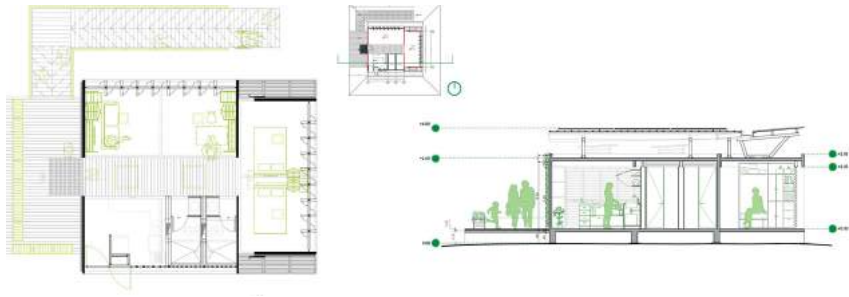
Planos de la propuesta Mihouse (Archivo MIHOUSE PD – Project Drawings)
